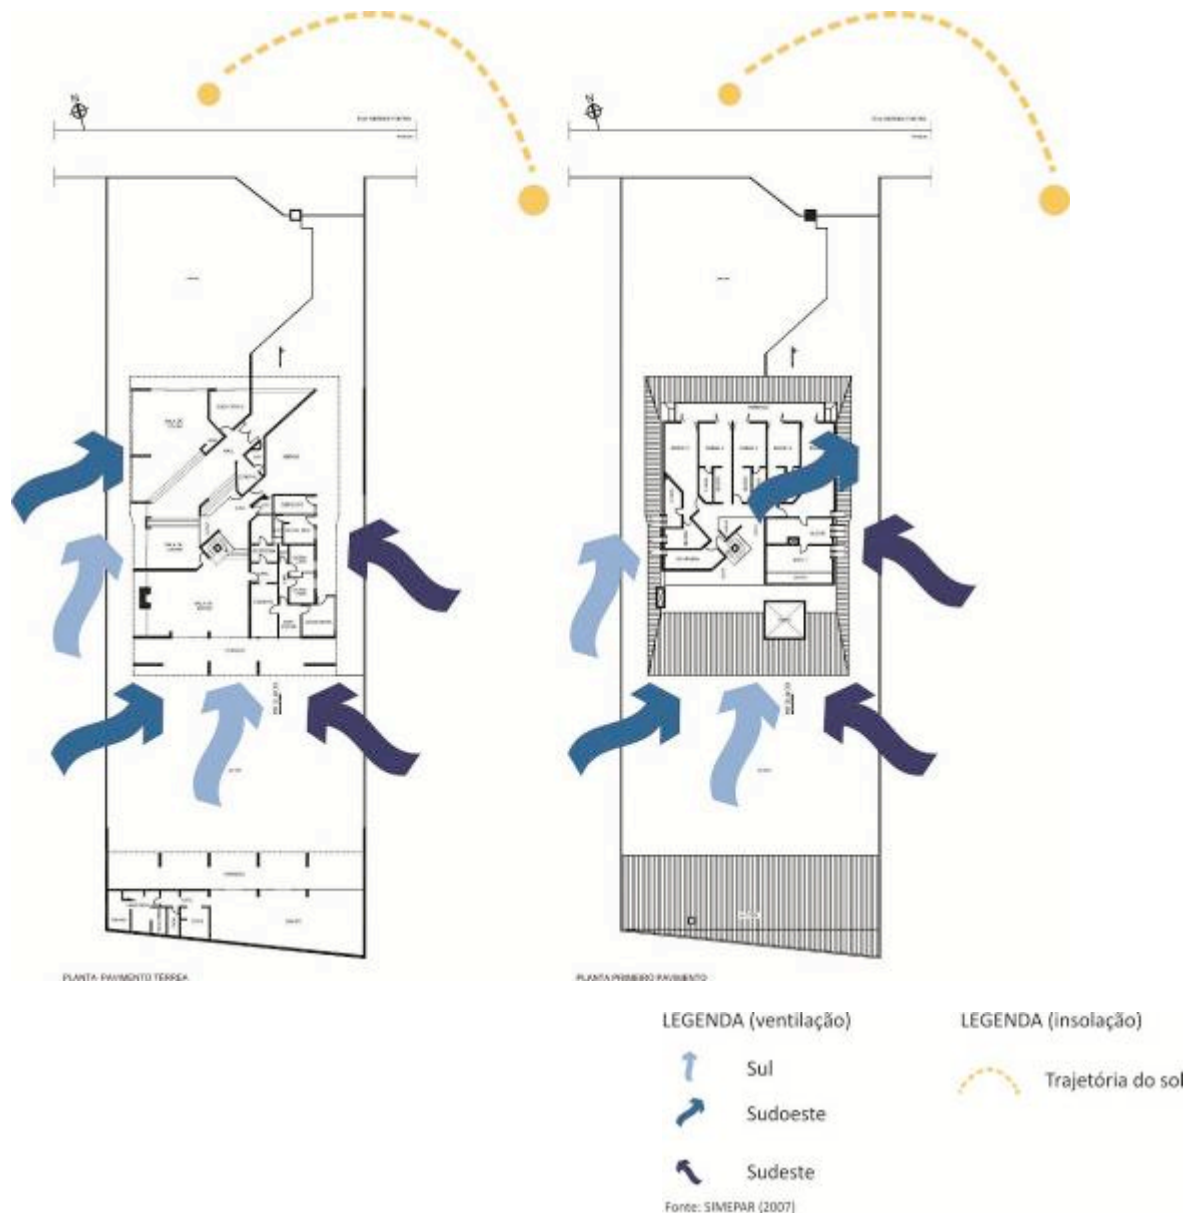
Plantas Pav. Térreo e Superior – Ventilação e insolação.
